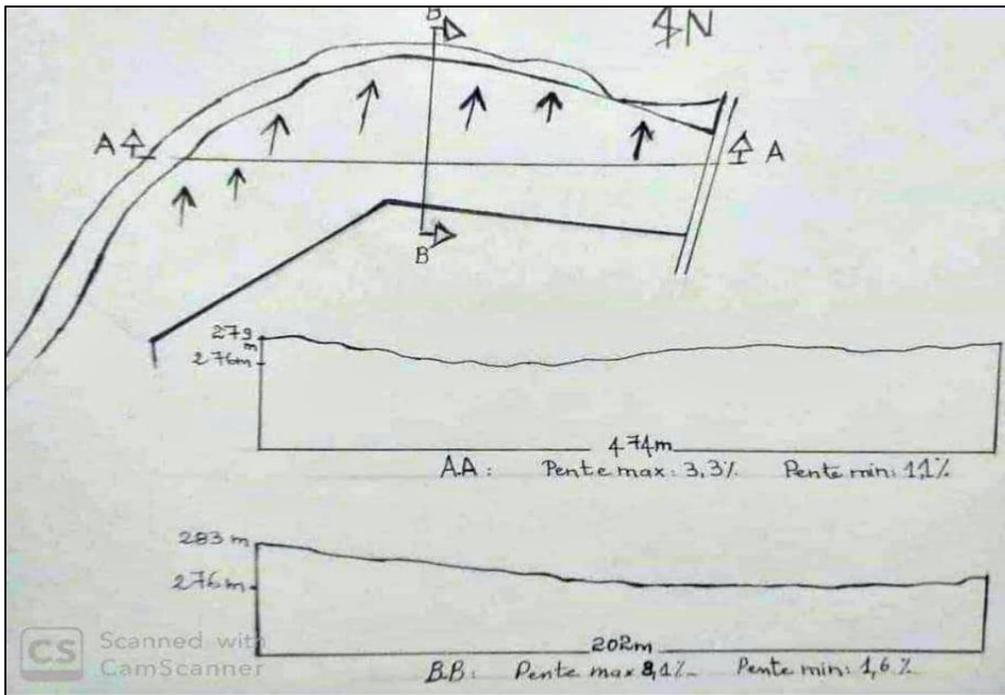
Figure 48 : coupe longitudinale et coupe transversale sur le terrain. (Source : auteur).
